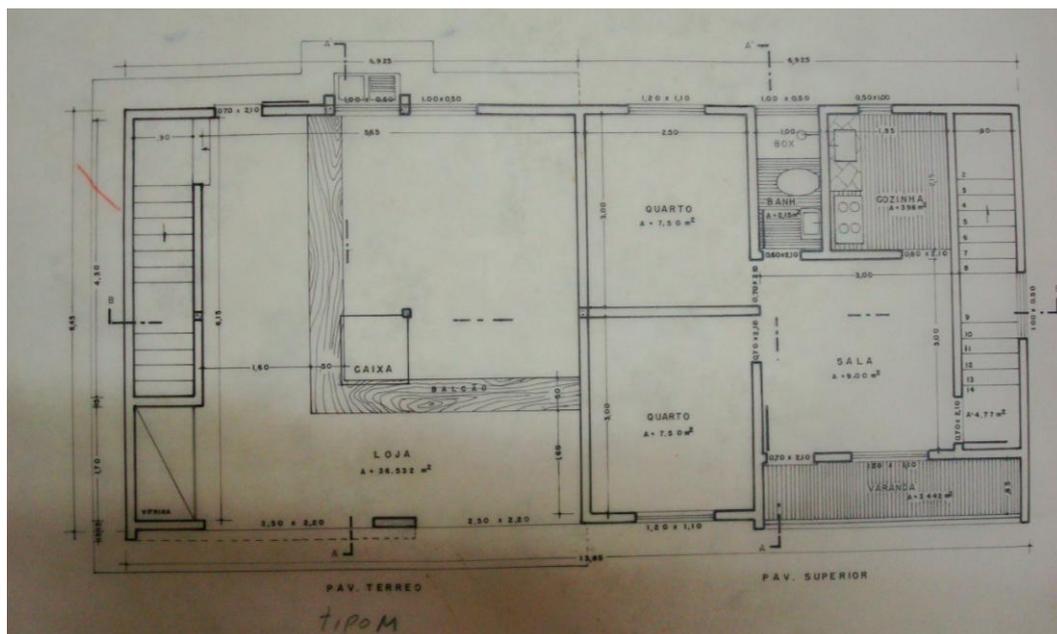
Planta baixa das casas tipo M (Fonte: Cohab)
